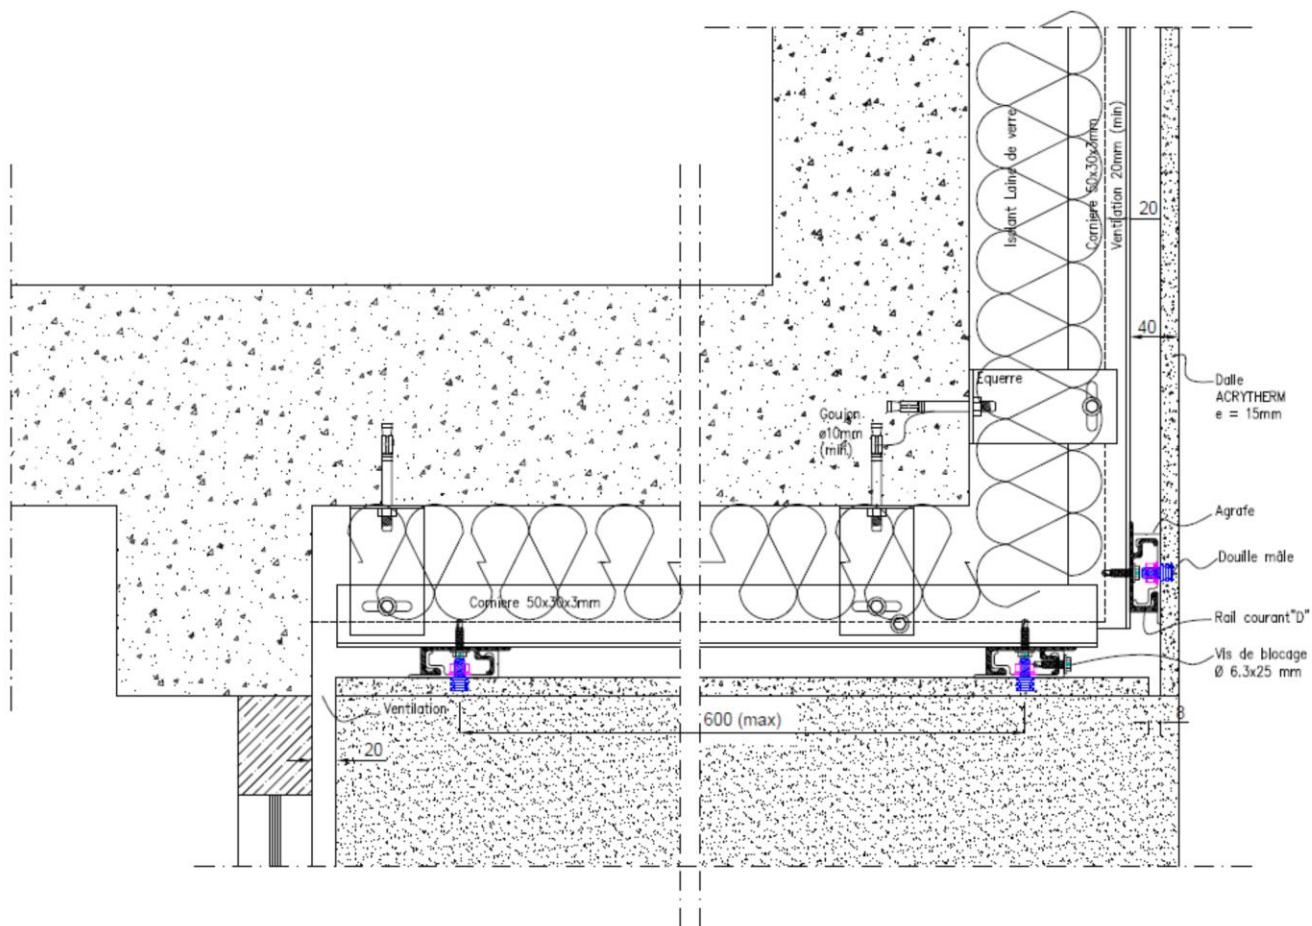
Coupe verticale sur linteau – Dalle indépendante – Fixation sur rails
